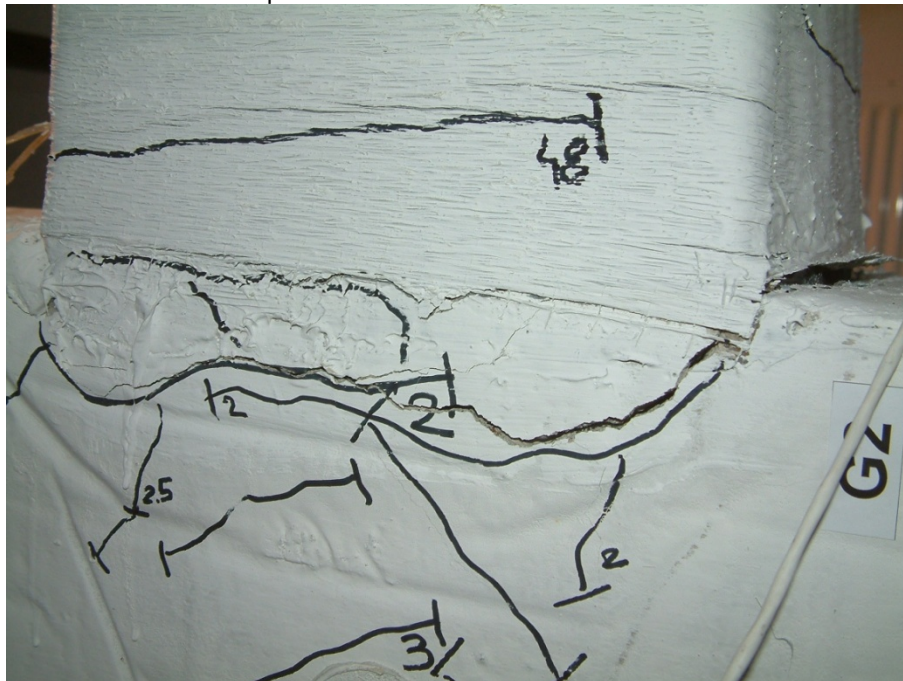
Formarea secțiunii de fisurare la baza consolidării pentru elementul C9C1-CSS-AF (30kN)
